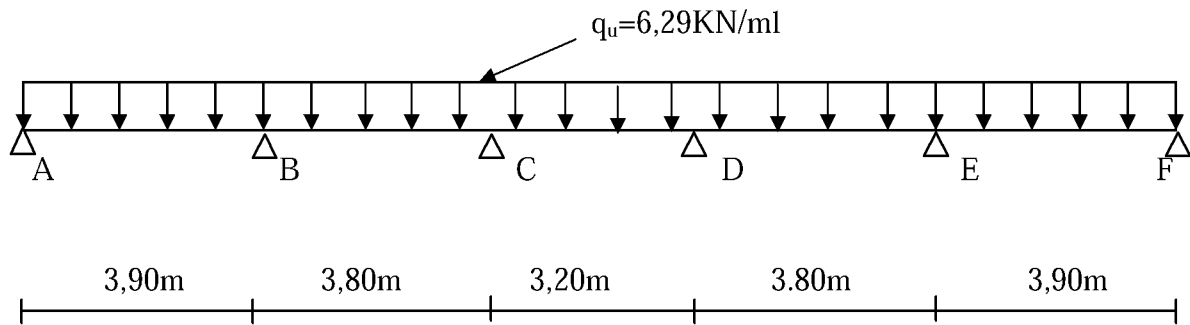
Schéma statique de la poutrelle sur 6 appuis.
